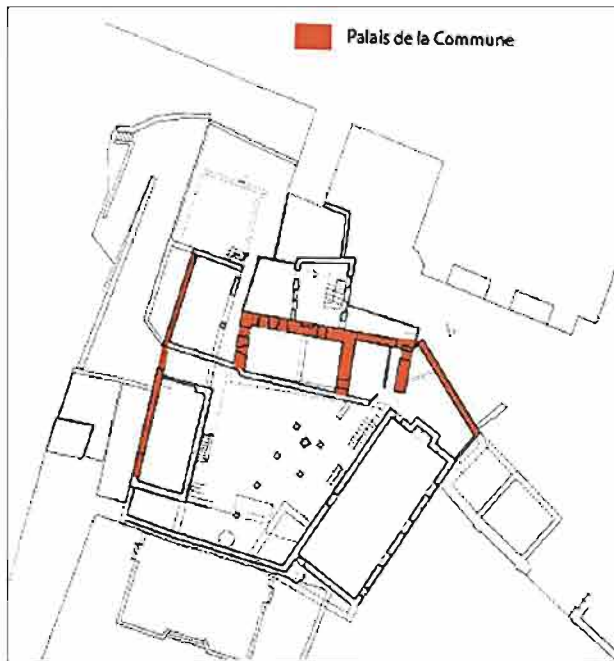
Avignone, planimetria del sito del palazzo dei consoli con, in rosso, gli elevati oggi conservati (Ch. Markiewicz).
